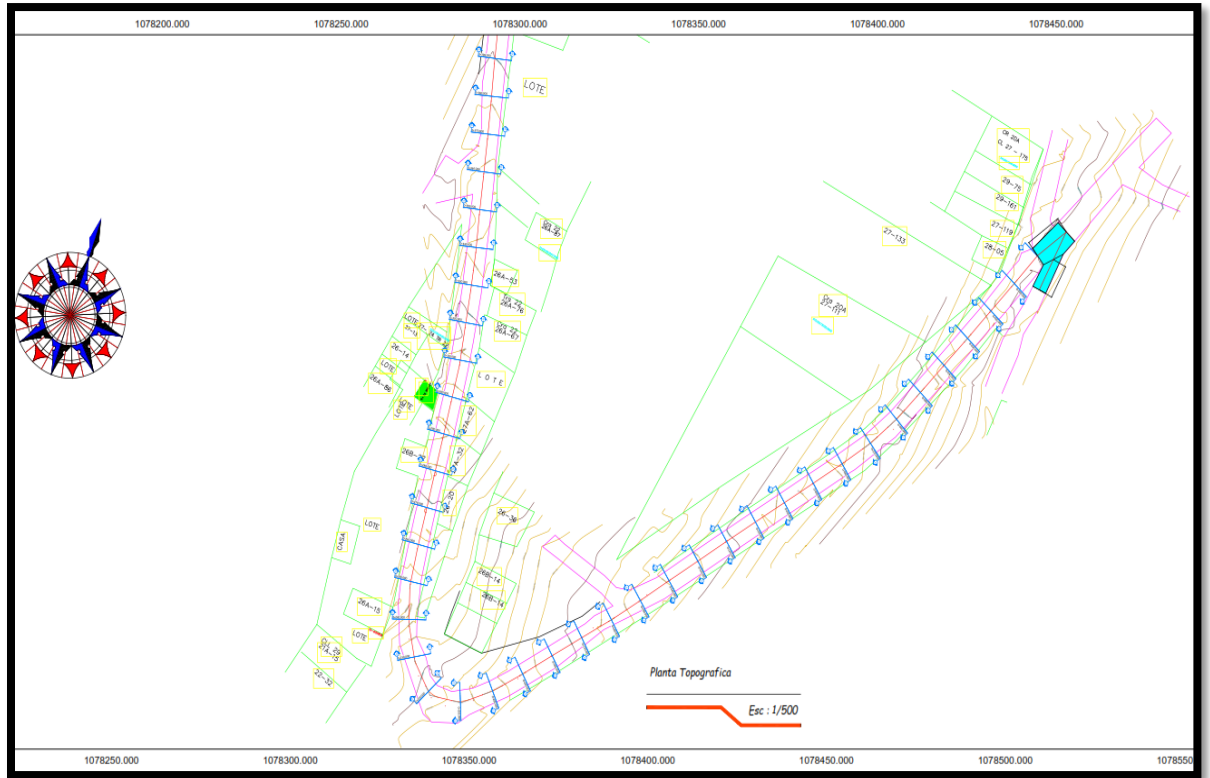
Plano topográfico de la vía La Capilla, San Lázaro.
